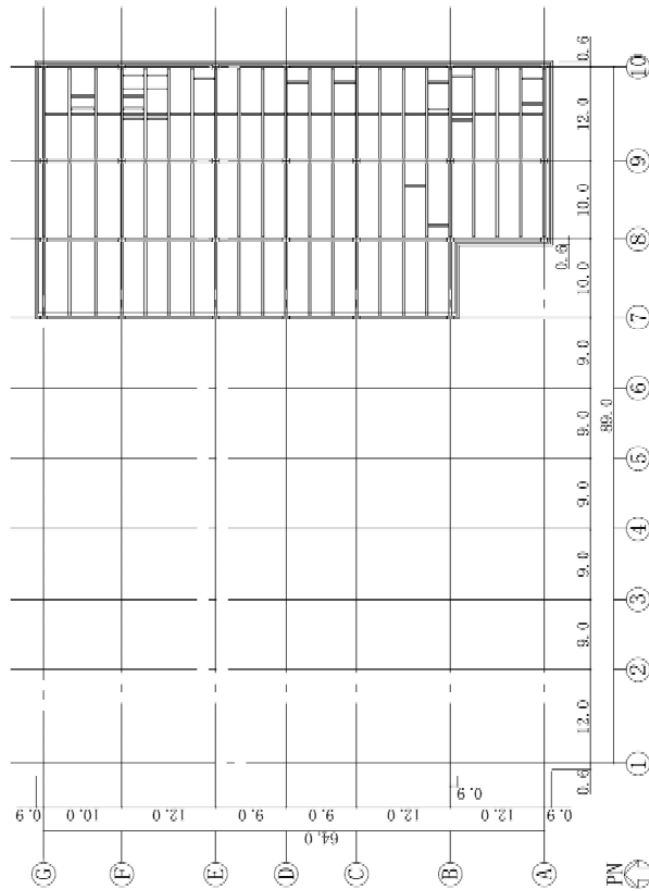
屋上階平面図 (G.L.+8.3) (単位 : m)
